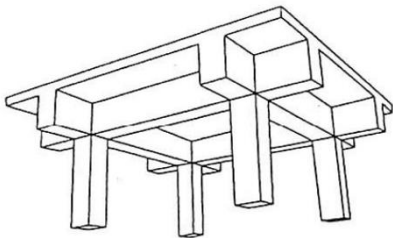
Losa de viga de canto en dos direcciones
